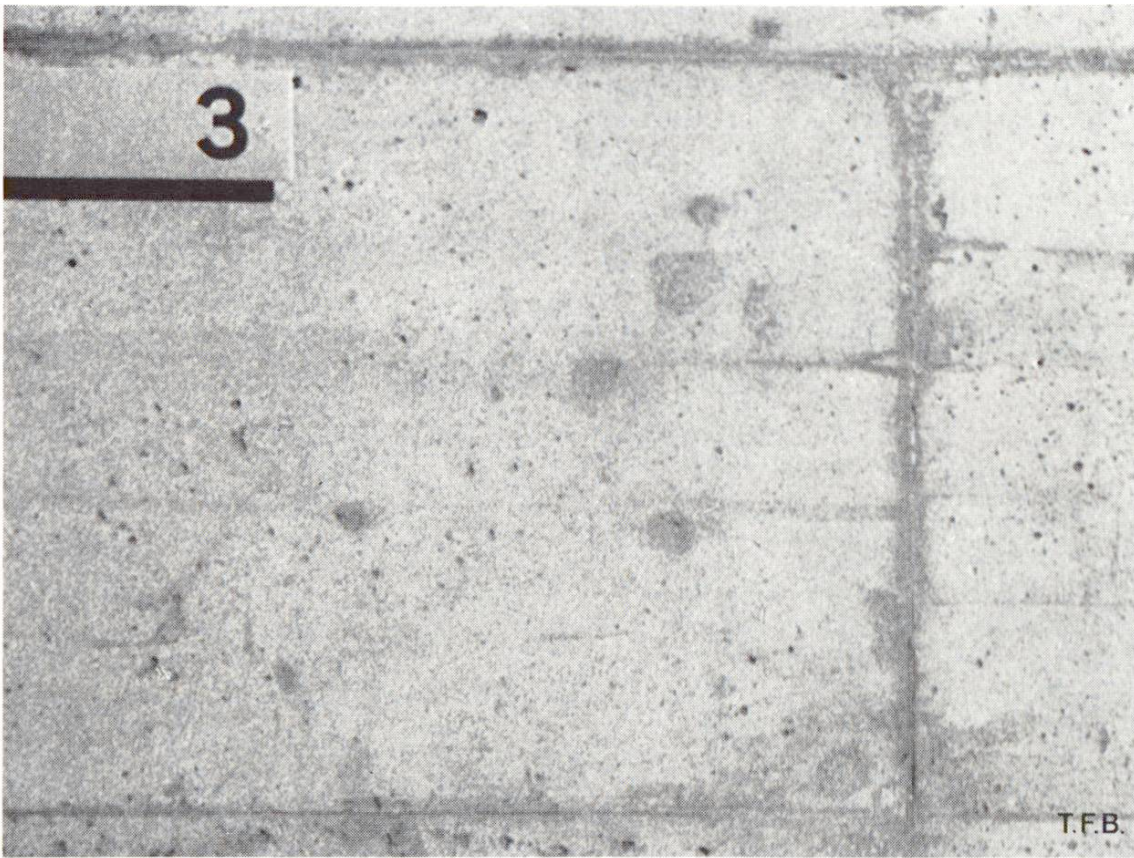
et 6 Mur de soutènement ayant même fruit que celui des figures 1 et 2. Photos 1962 et 1972. Béton P 300 bien serré, coffrage en planches imprégnées. Assombrissement général de la surface dû aux lichens et à la dissolution de la pellicule superficielle de chaux. Les traces foncées du début, le long des joints de coffrage sont devenues claires. C'est la conséquence de la posthydratation et de l'absence de mousse sur ces zones particulièrement denses et riches en ciment. On remarque aussi l'augmentation du nombre des pores superficiels qui étaient à l'origine recouverts d'une mince couche de lait de ciment. Les nœuds du bois sont devenus plus visibles. Cela est dû à la croissance de mousses dans ces zones plus poreuses. Le phénomène est le même le long des joints de coffrage qui n'étaient pas étanches. La tache au coin inférieur du panneau de coffrage a de multiples causes. Nœud du bois, mauvais serrage et ségrégation ont provoqué à cet endroit une porosité plus grande du béton.
